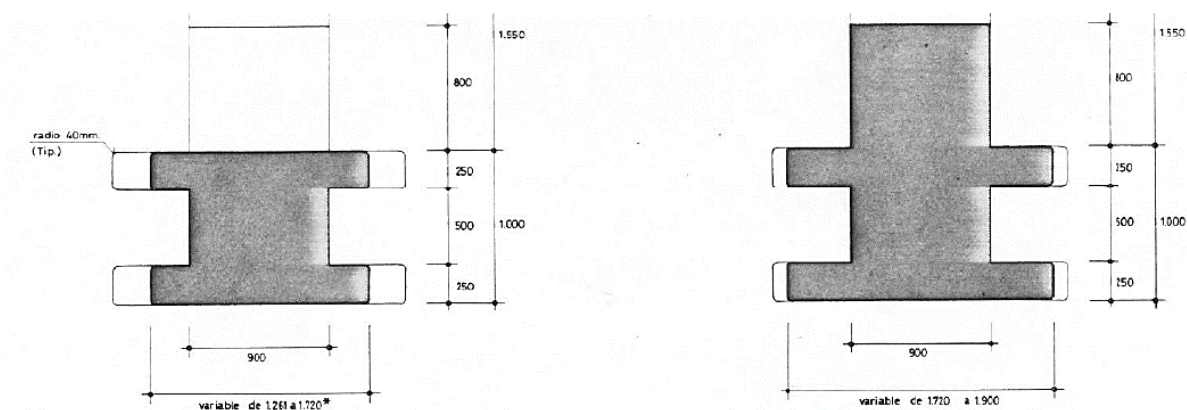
Planos de las secciones transversales del pilono sobre el tablero (izquierda) y debajo de él (derecha). (Fuente: Proyecto de construcción original).
